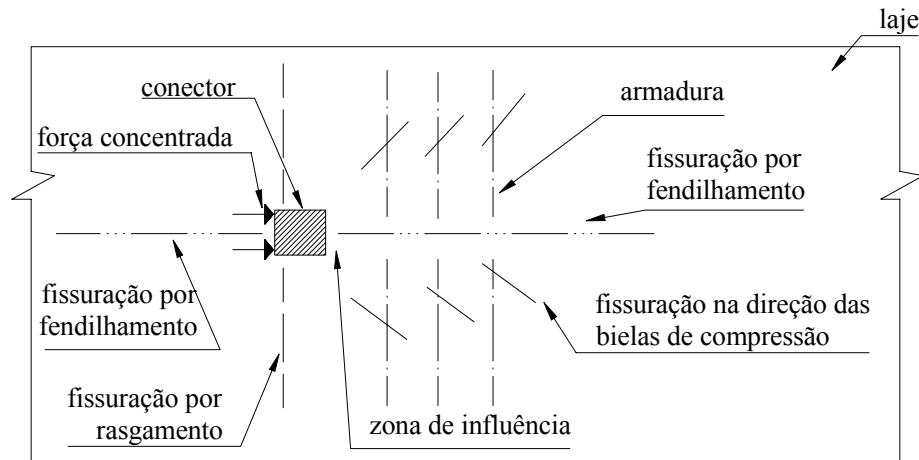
Tipos de fissuração na laje devido à força concentrada, TRISTÃO (2002).
